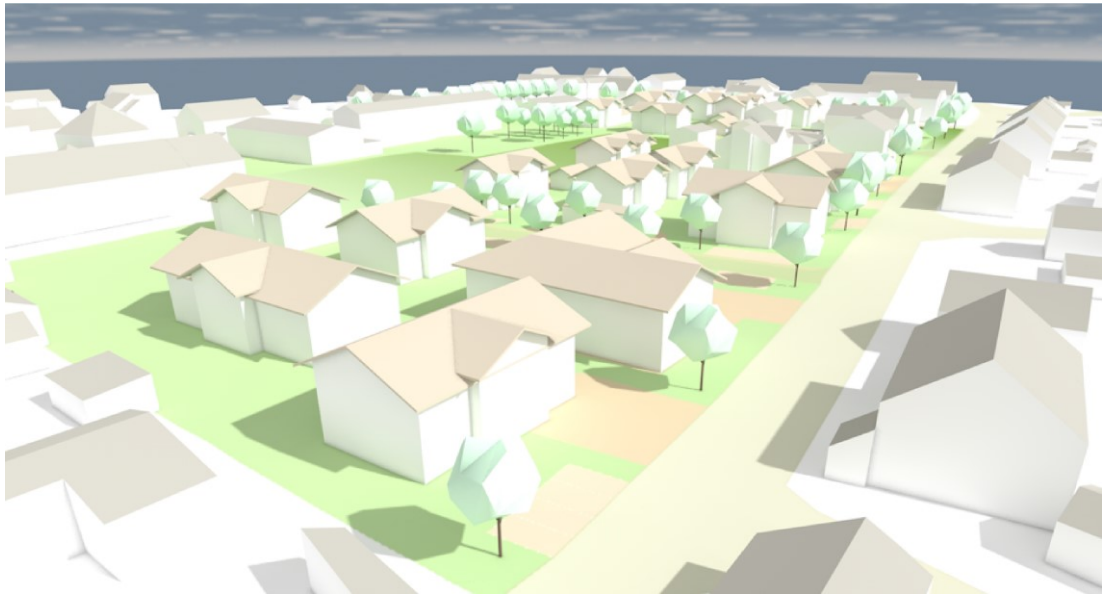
Visualisierung der zukünftigen Höhenentwicklung mit Dachaufbauten, ohne Maßstab
